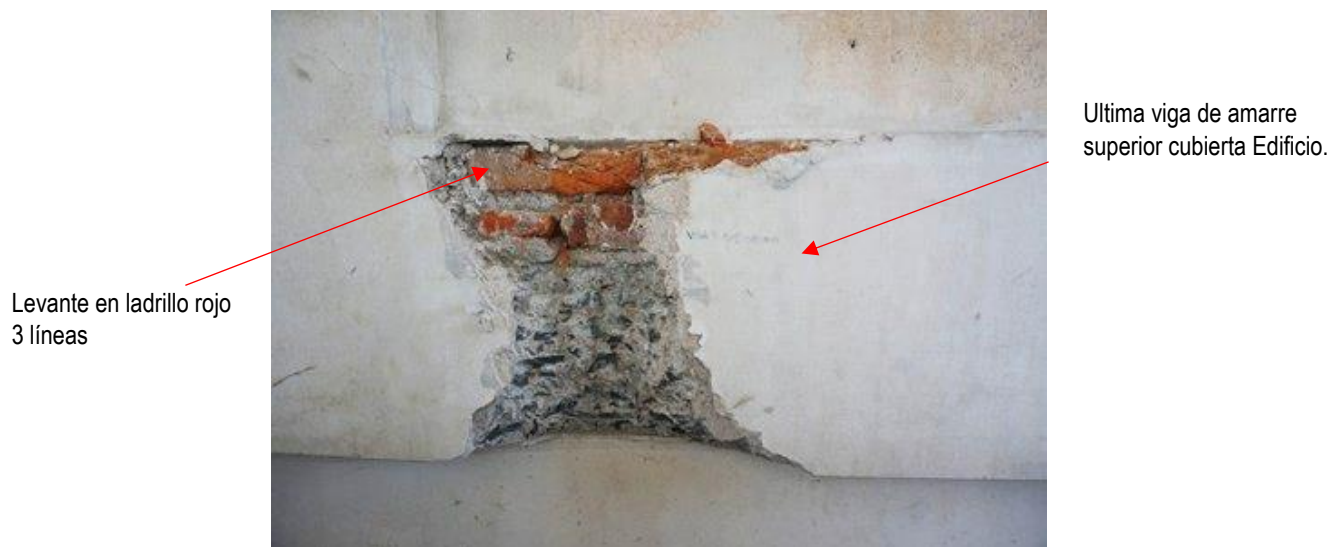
Detalle Ventana viga TRAMO F2-F3, se aprecia un levante sobre la viga y la distribución de los agregados.
